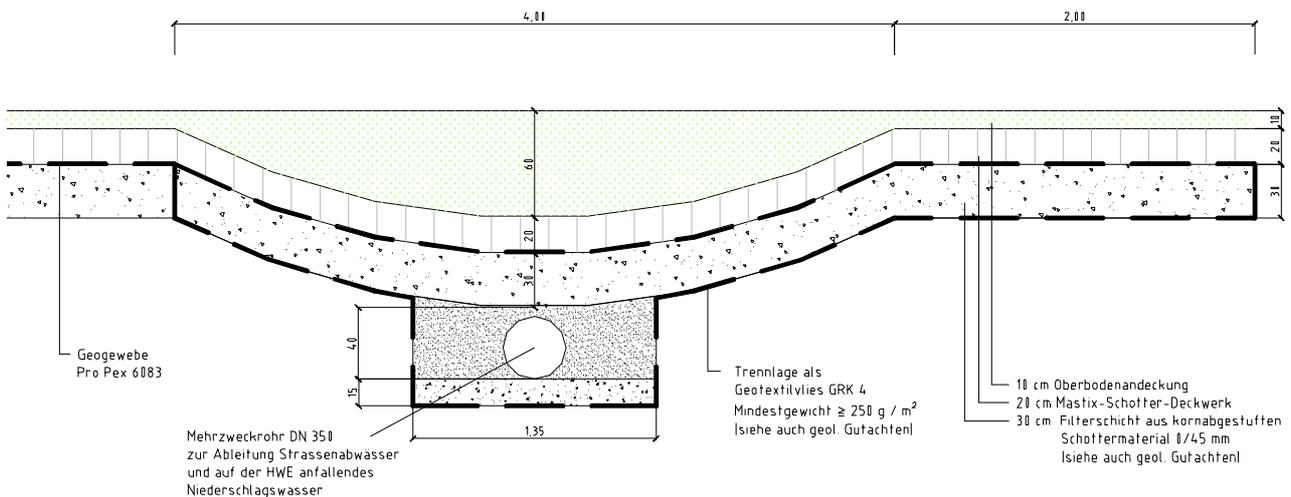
Kolkeintiefung am Dammfuß beim Mastix-Schotter-Deckwerk
